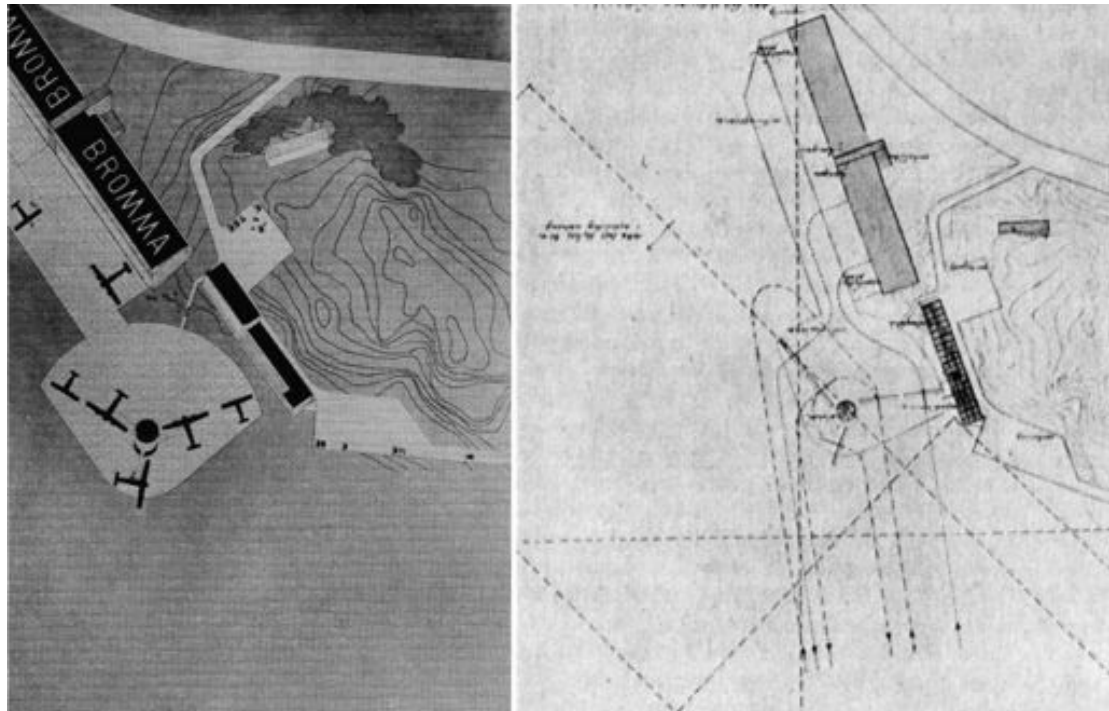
Sigurd Lewerentz, alternativ A; Friliggande angöringspaviljong ansluten via en gångtunnel till stationsbyggnaden vid Ranhammarshöjden.
